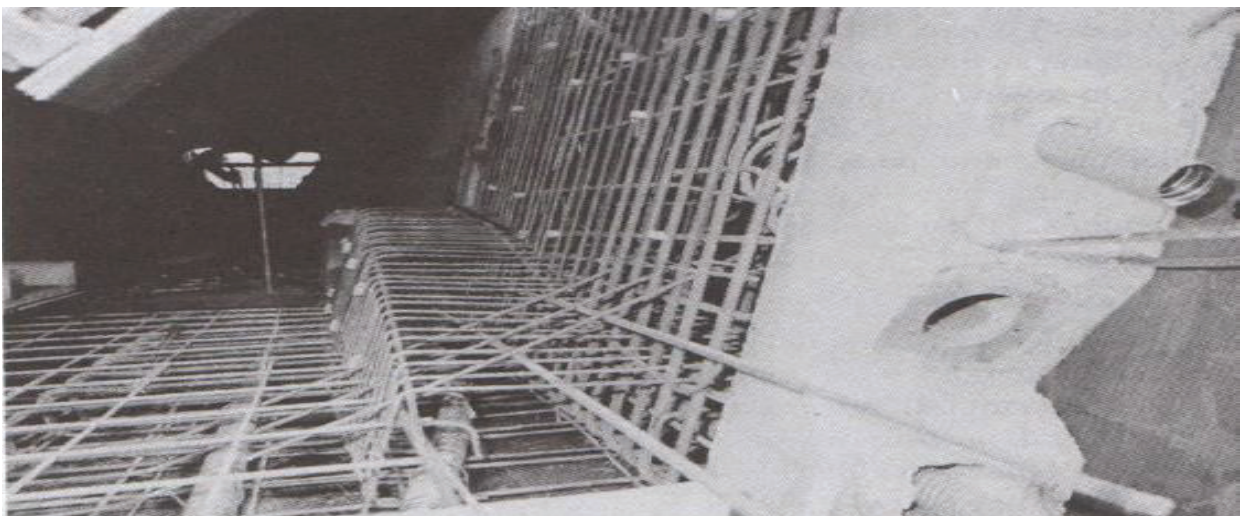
Ferrailage d'un bossage d'ancrage d'un câble de continuité.
